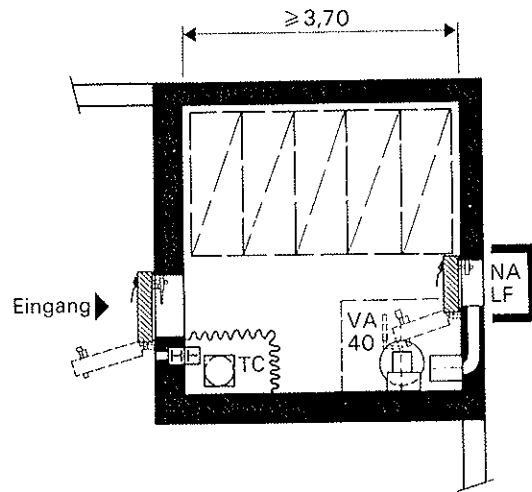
Grundrissform für 10 Schutzplätze (Bodenfläche $\geq 11 \text{ m}^2$)
